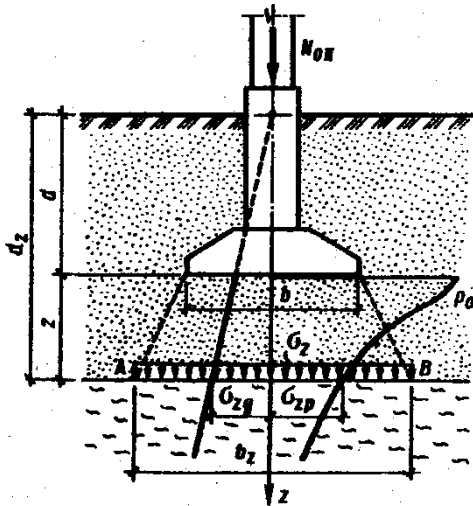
Расчётная схема к проверки давления на подстилающий слой слабого грунта
